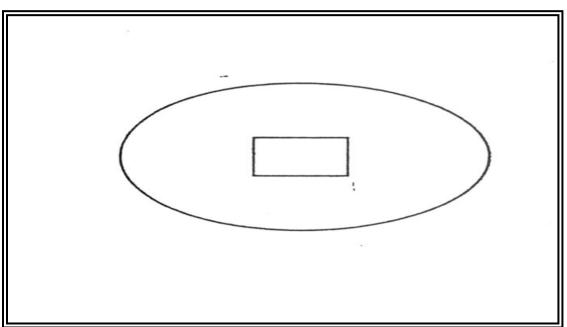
مسقط أفقي لجزء من قناة عين وادي قوز (المصدر غباشي: إيصال مياه العيون)مقياس ٢:١.
